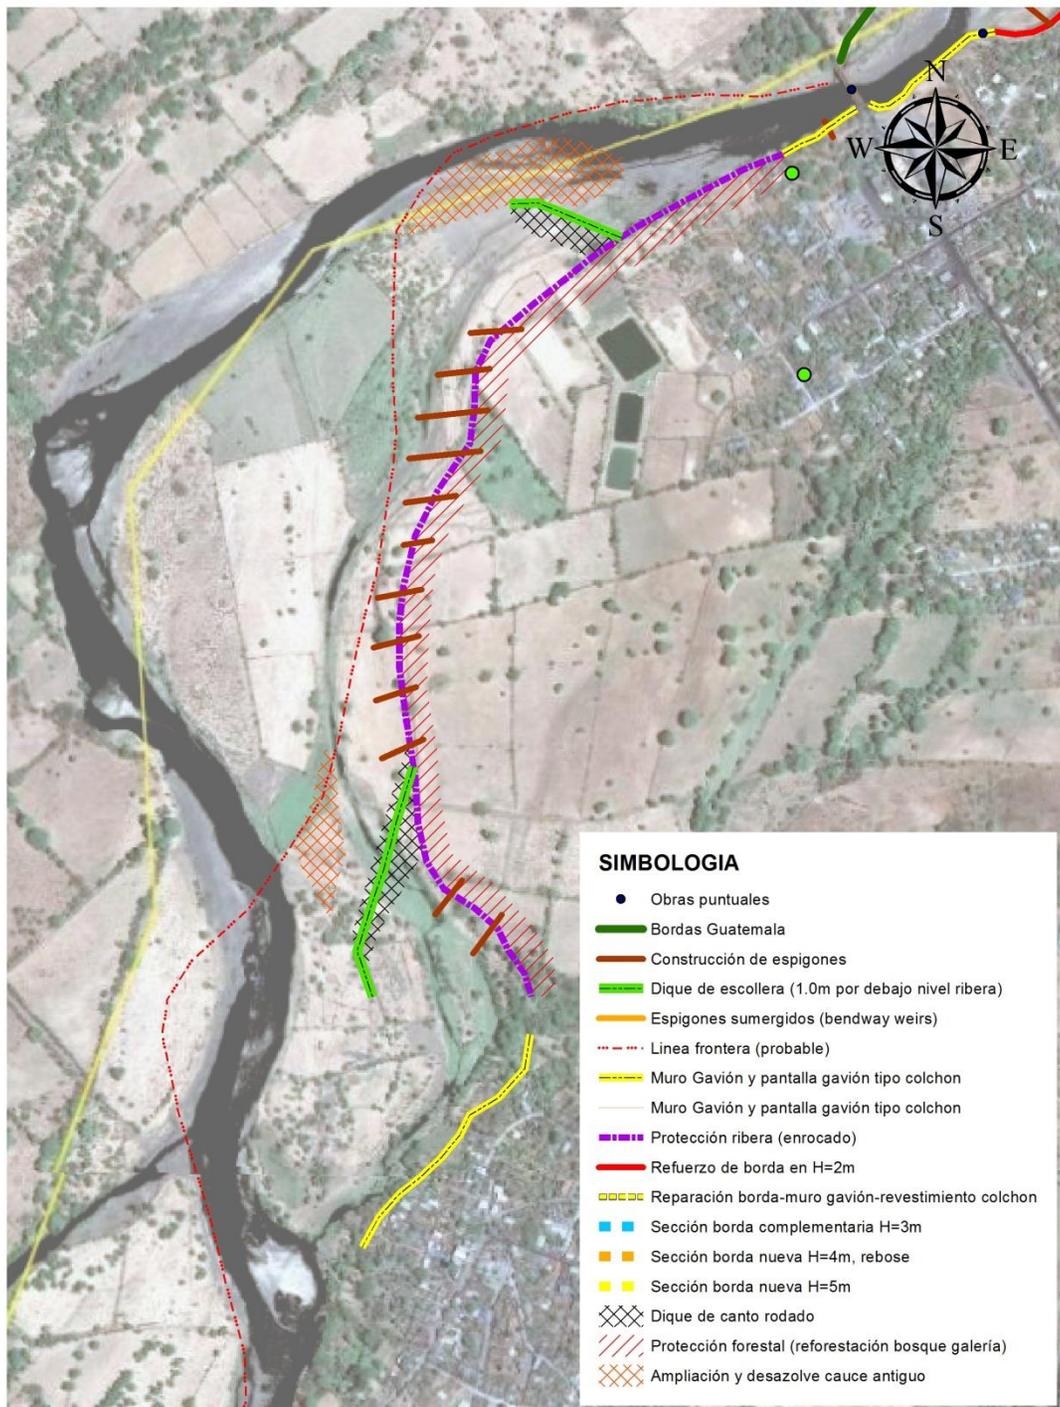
Vista en planta de estructura tipo espigón construida en sector La Hachadura.
